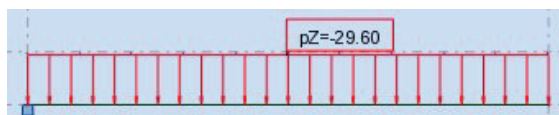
Schéma statique du mur de couronnement en profil enracinement (jetée principale)
